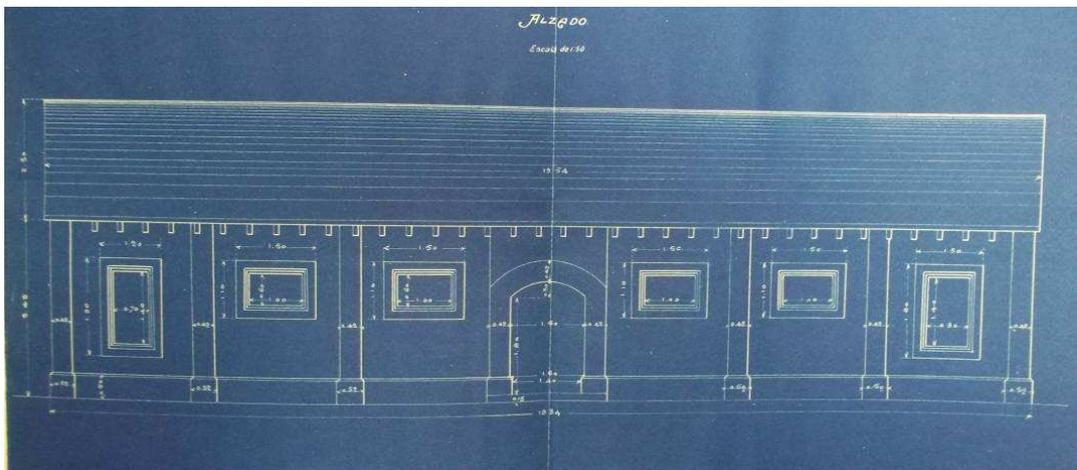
Alzado de la cuadra de Calahorra. Eduardo Fungairiño, 18 de julio de 1924
